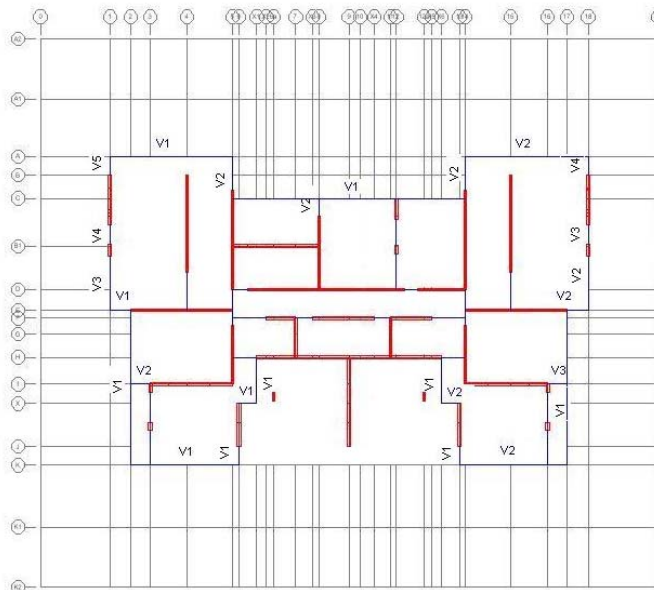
Numeración de vigas en Piso 1 – Edificio de Muros
